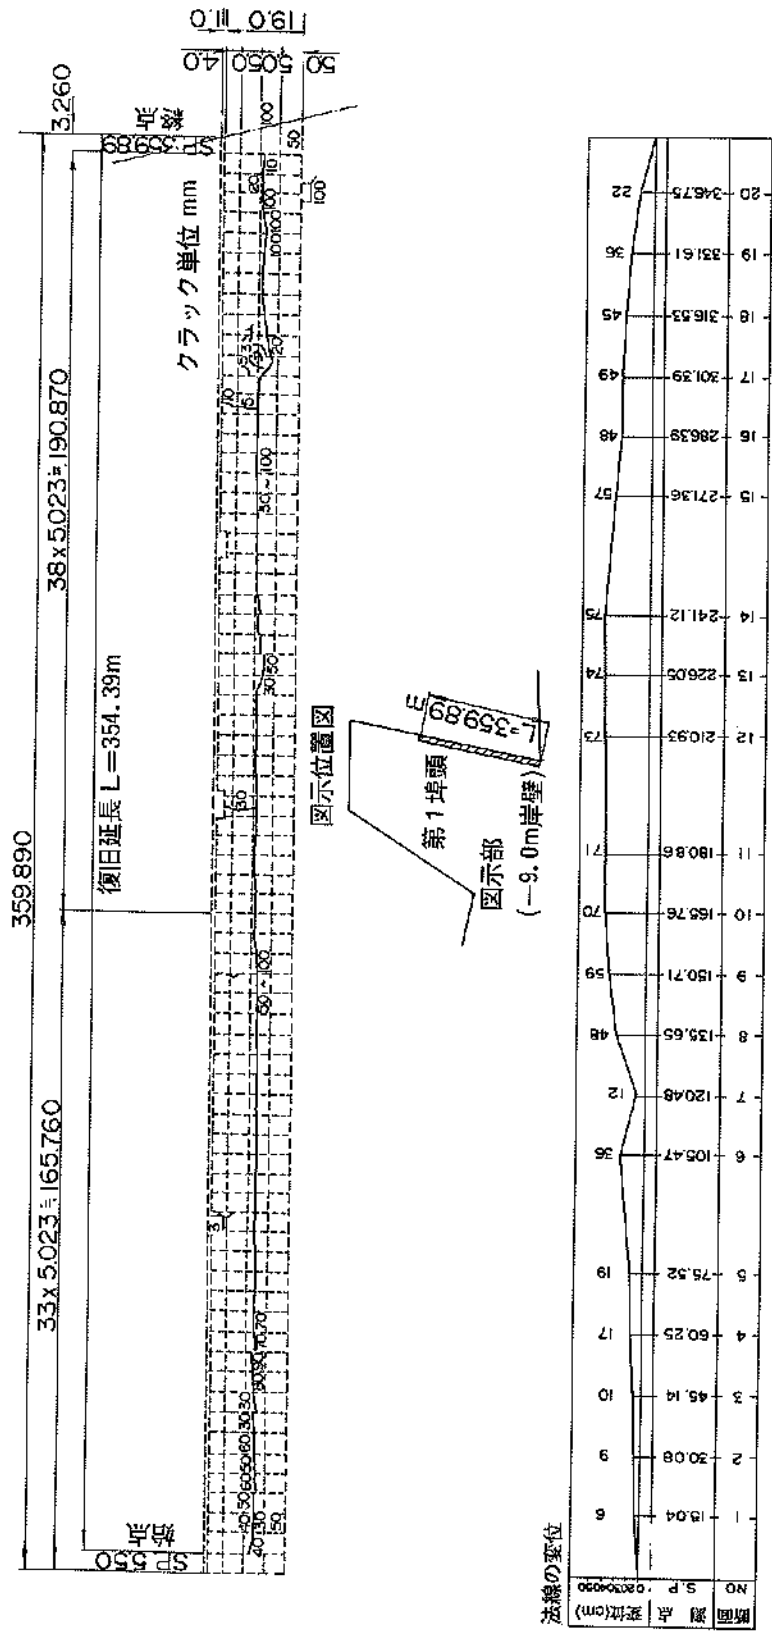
被災状況平面図・法線変位図 (第1埠頭地区, ㊸・㊹西側岸壁(-9.0m))
